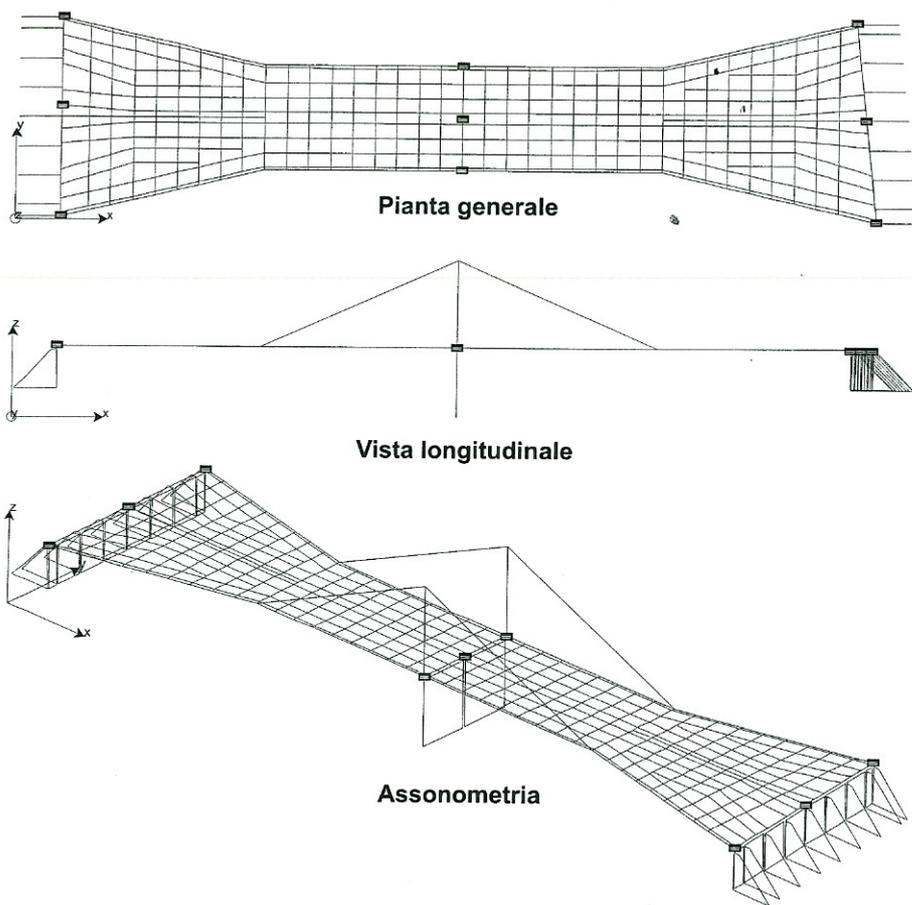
Il ponte: Sezioni longitudinali e pianta
